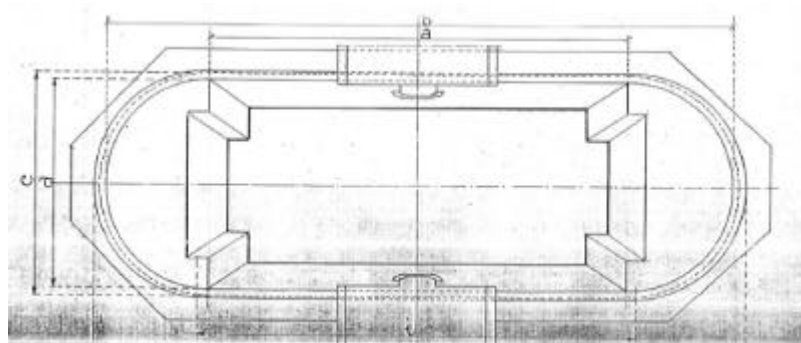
sezione di una *pila-spalla* del viadotto Ellero - linea Fossano-Mondovì, progr. 19+722 (Archivio FS - TO).
